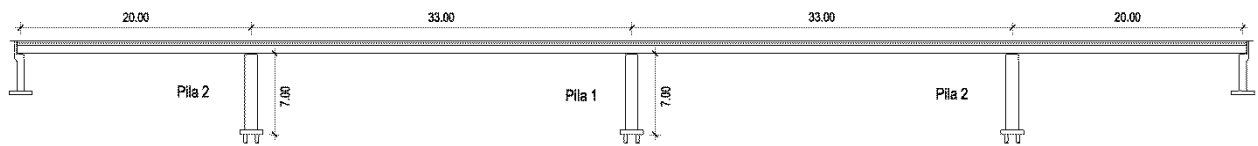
Alzado (Puente continuo cuatro vanos)
